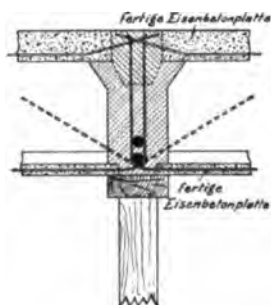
Herstellung einer unten ebenen Decke unter Verwendung fertiger Eisenbetonplatten.
